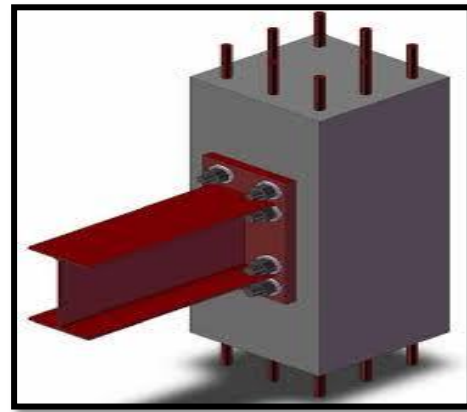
détail d'assemblage poteau béton armé / poutre métallique
